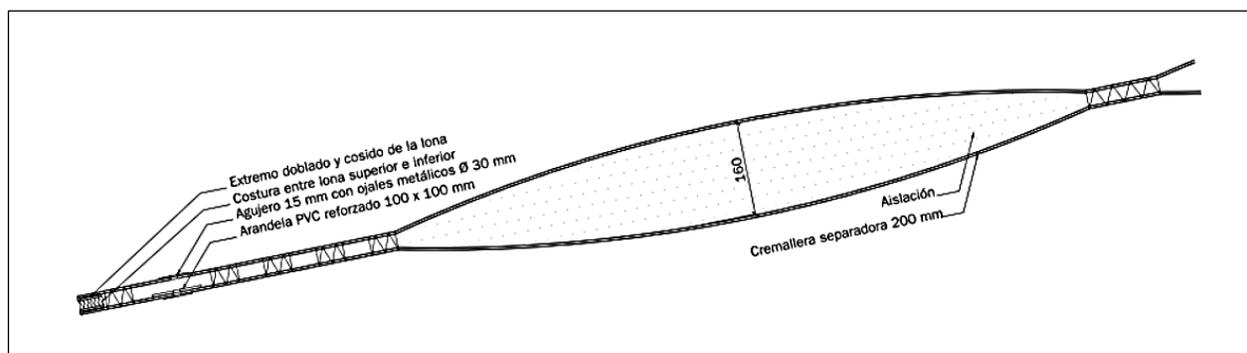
Detalle de amarre de lona a cubierta Red+Housing
